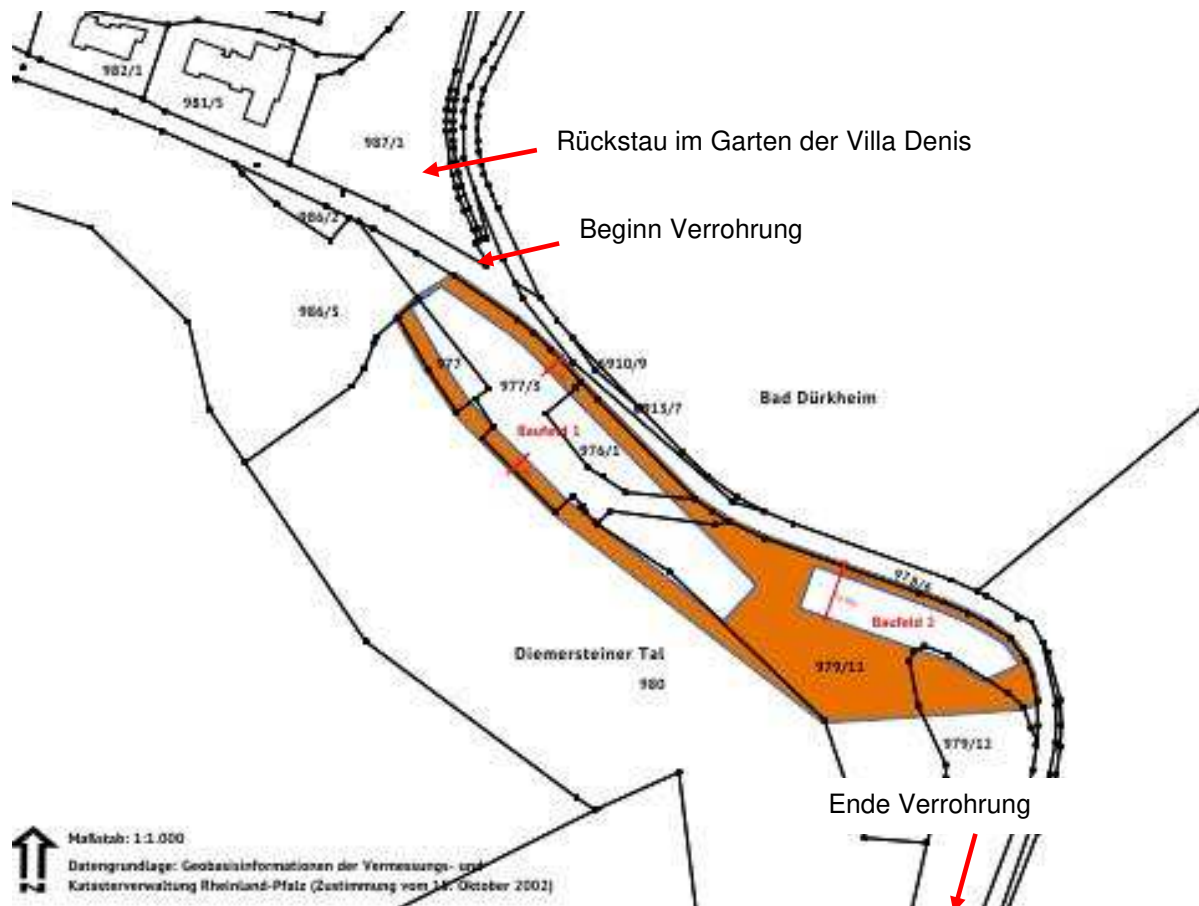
Bebauungsplan Lageplan Holzbau-Campus
